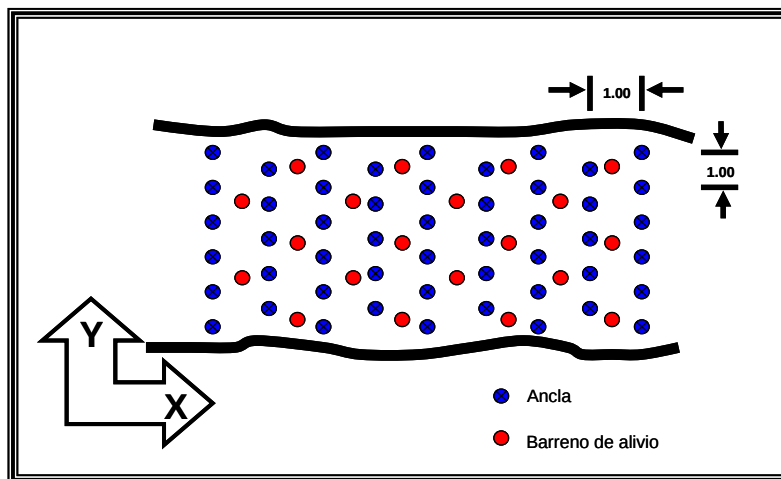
Plantilla de anclaje en sección de 1 X1 m, con barrenos de alivio
